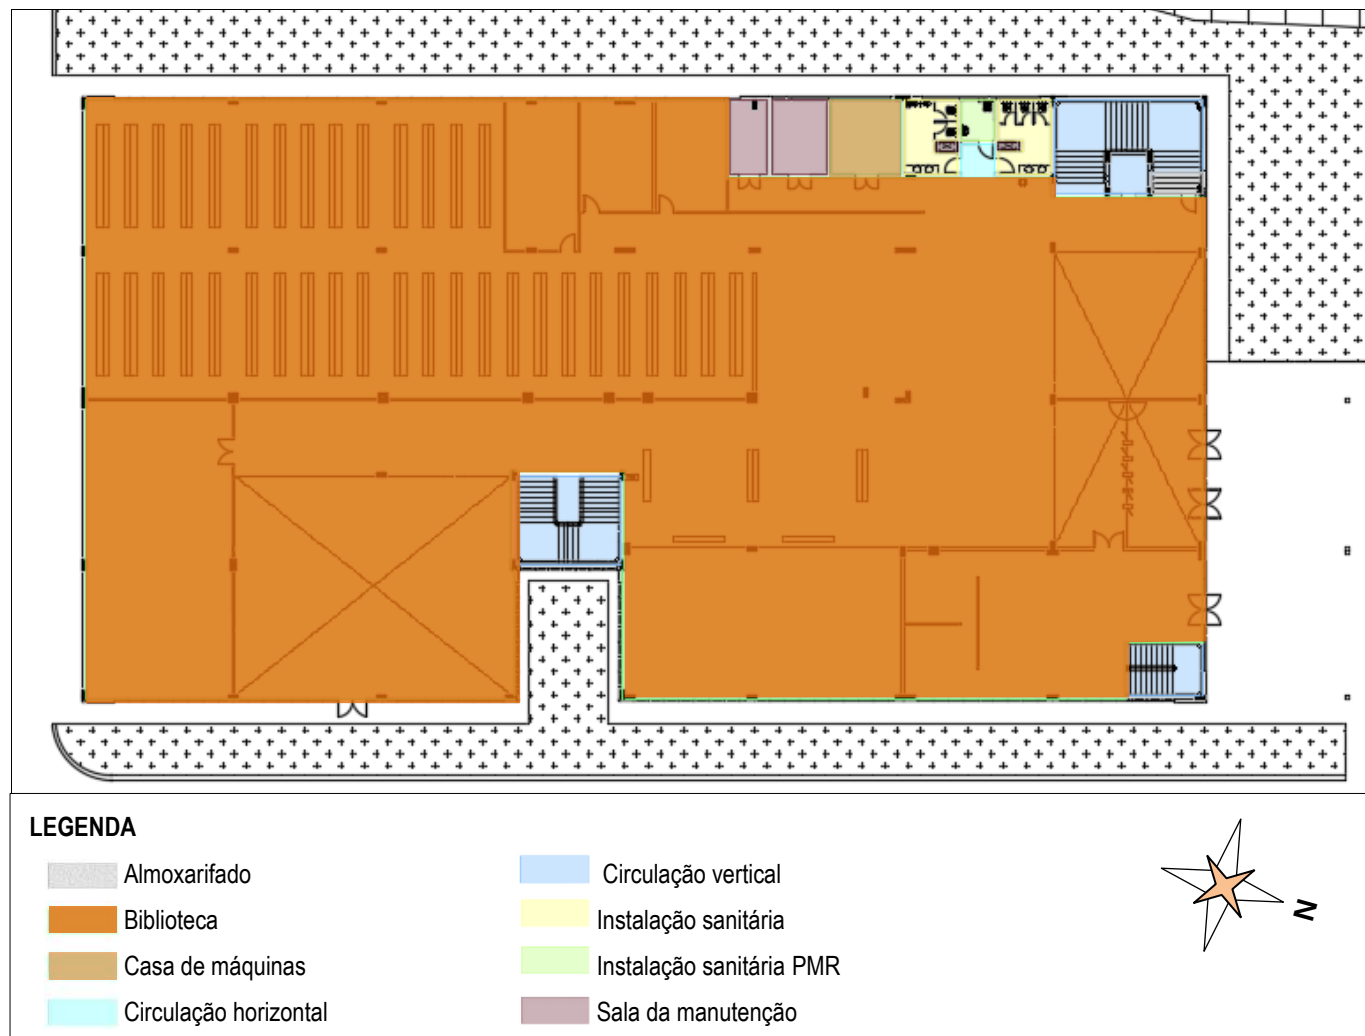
Planta setorizada do pavimento térreo do bloco 08.
